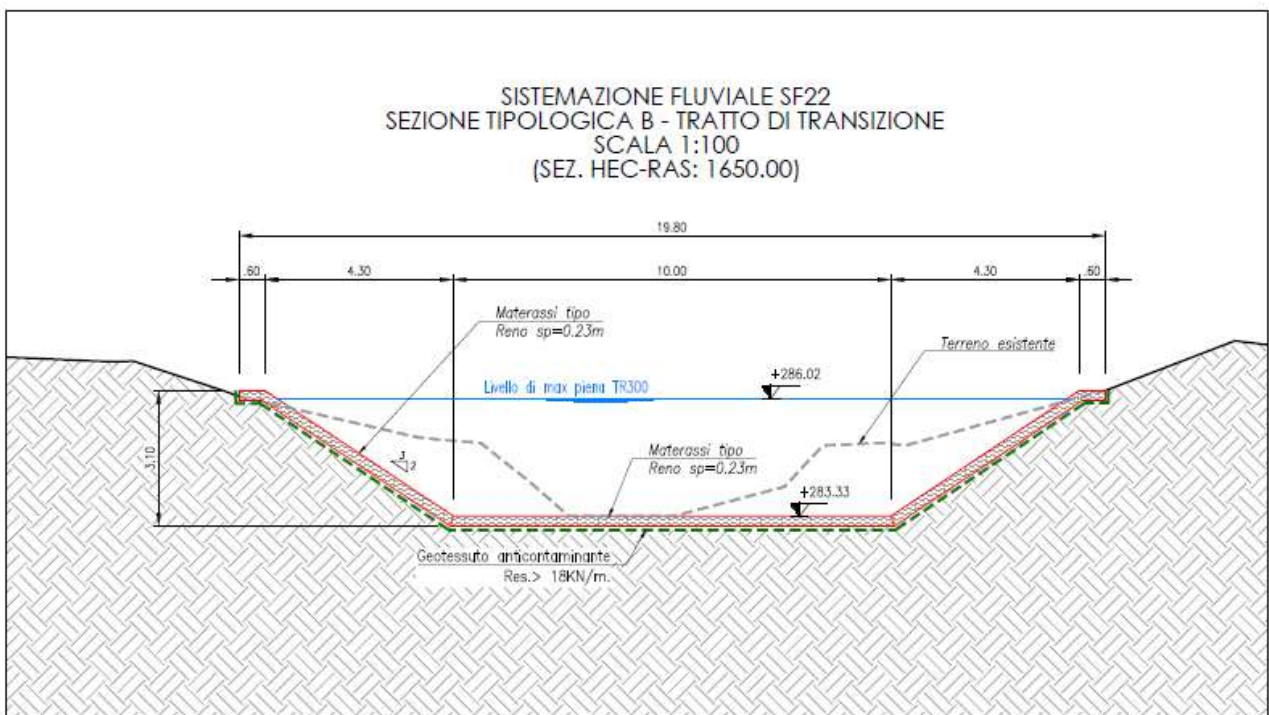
Sezione tipo B sistemazione "SI22" - elaborato di P.V.T.2 codifica PEID_B026_50_4137.
